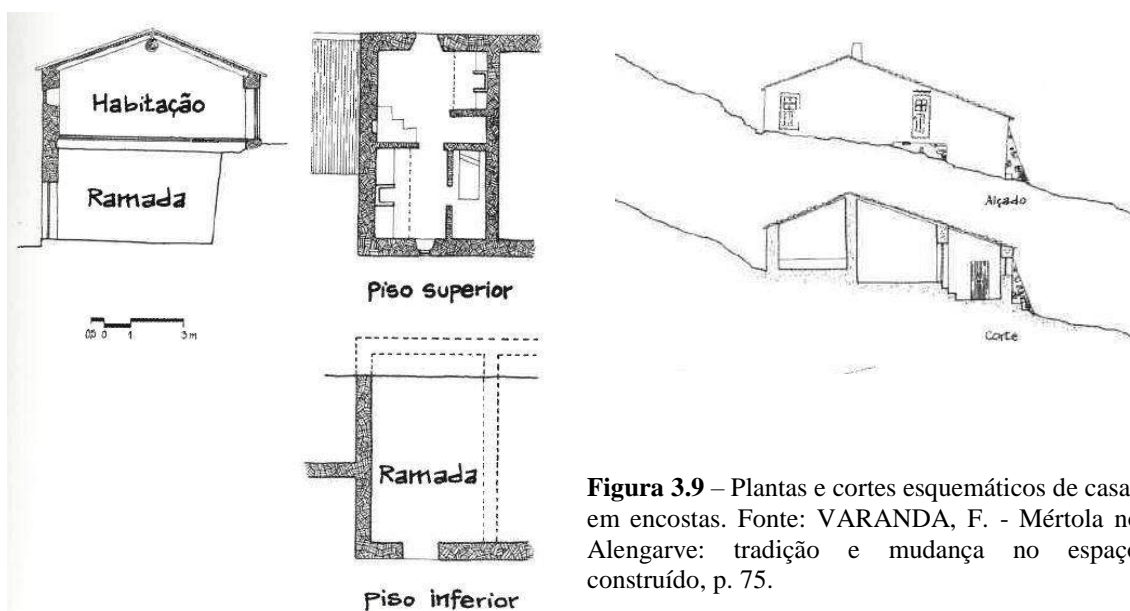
Plantas e cortes esquemáticos de casas em encostas. Fonte: VARANDA, F. - Mértola no Alentejo: tradição e mudança no espaço construído, p. 75.
